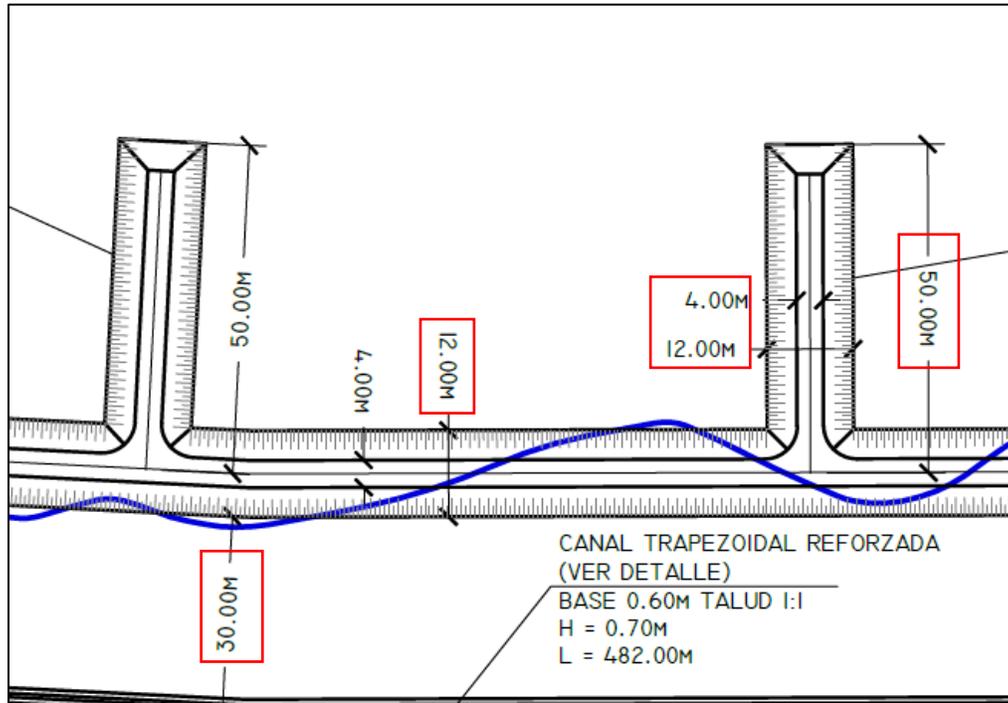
Planos y medidas para la construcción del muro. Diseño y construcción del camino Garachiné – Sambú, camino a la Colonia – Bayamón, ramal al antiguo puesto de compra y muro de protección en Garachiné. Fuente: Ministerio de Obras Públicas, febrero 2016.
